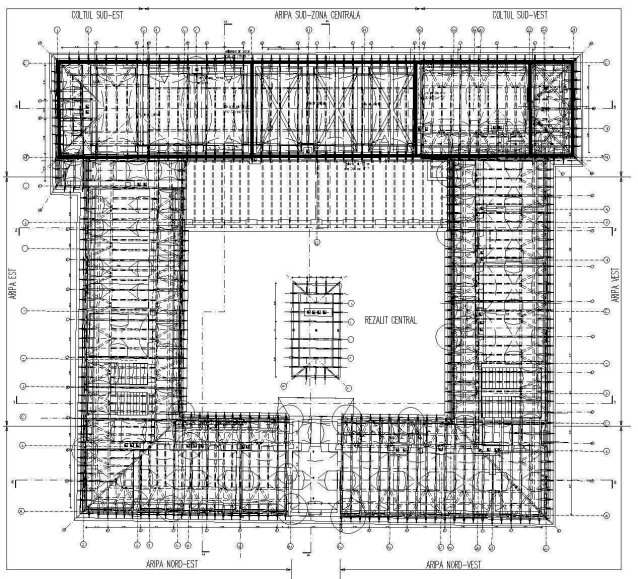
a. – Plan sinteză intervenții structurale – șarpanta Colegiului Reformat, Cluj-N.
